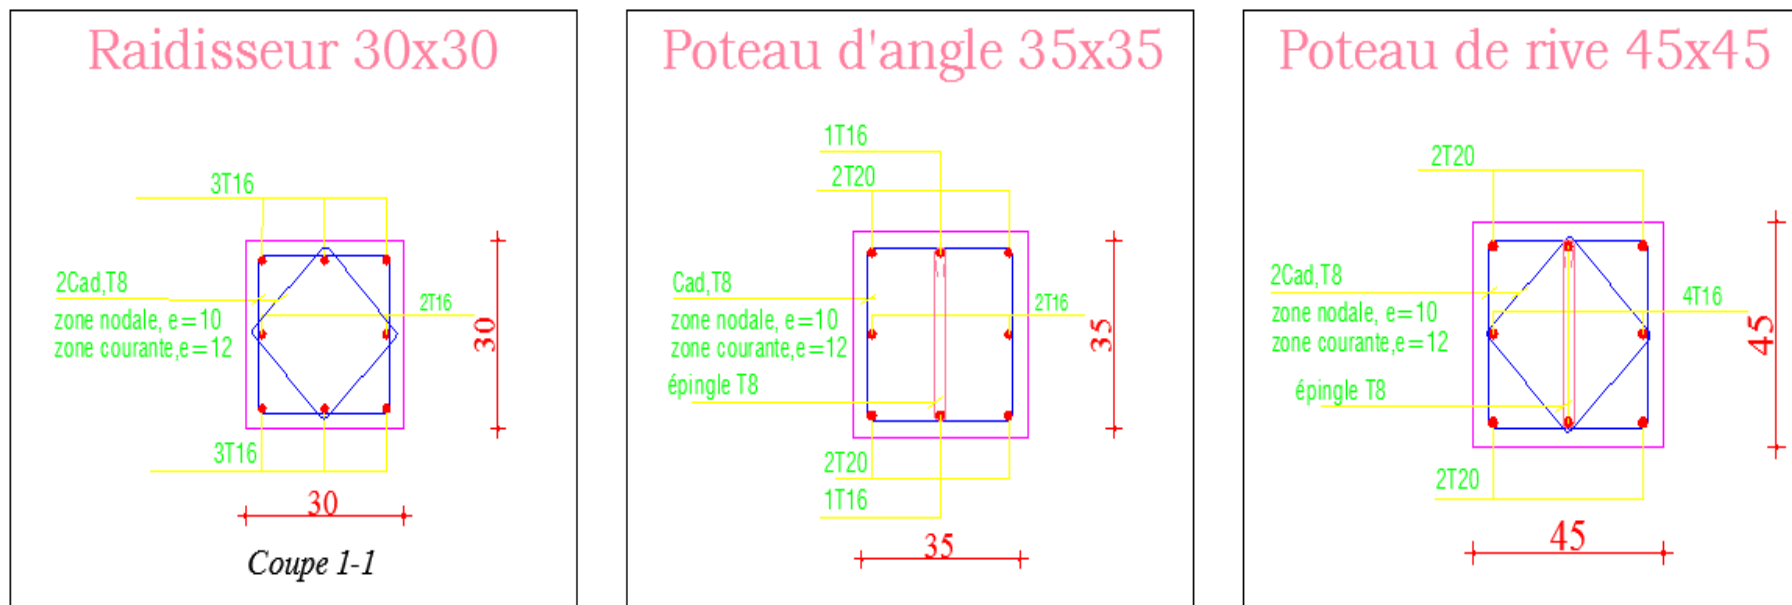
Ferrailage des poteaux de rive, poteaux d'angle, raidisseurs
